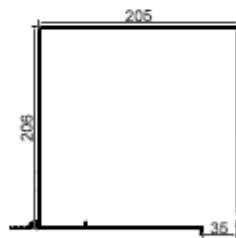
Querschnitt Rolladenkasten (SP-E 205)
